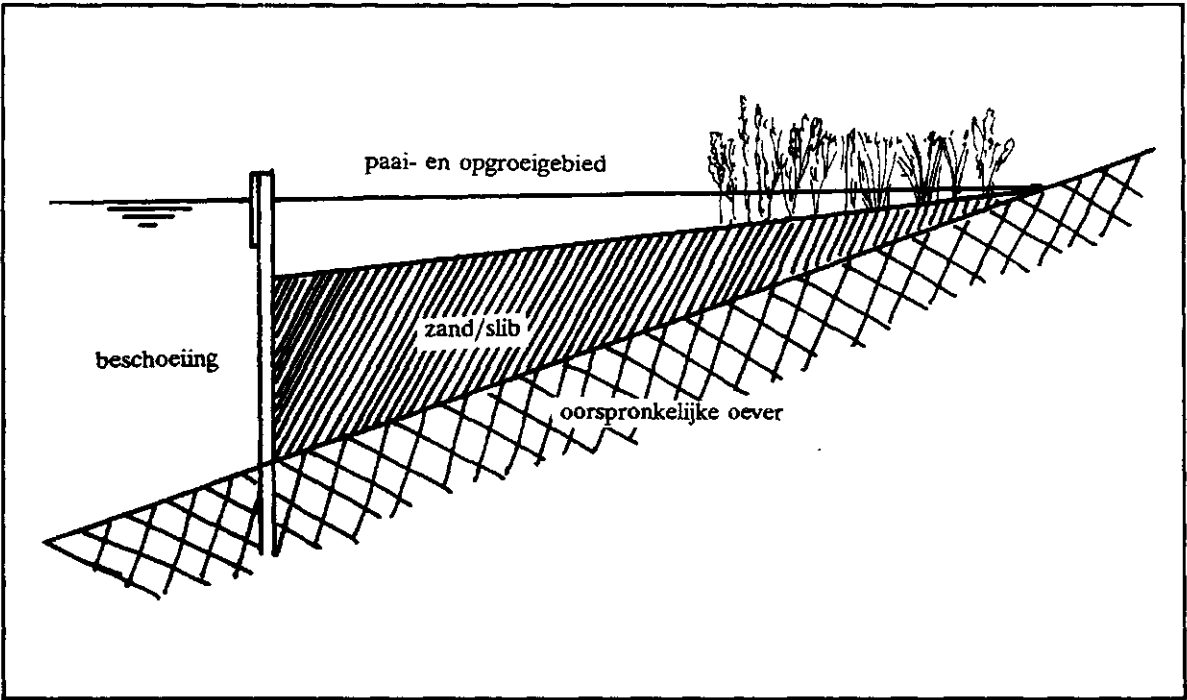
Zijaanzicht paai- en opgroeigebied type 1 (schaal 1:200)
